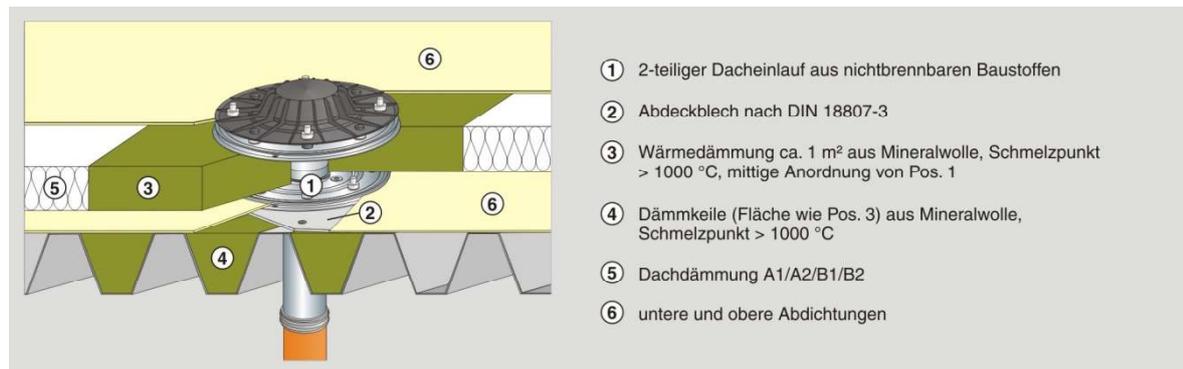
Durchdringung eines großflächigen Daches, z. B. Trapezblechdach mit nichtbrennbaren Rohren / Dachabläufen
